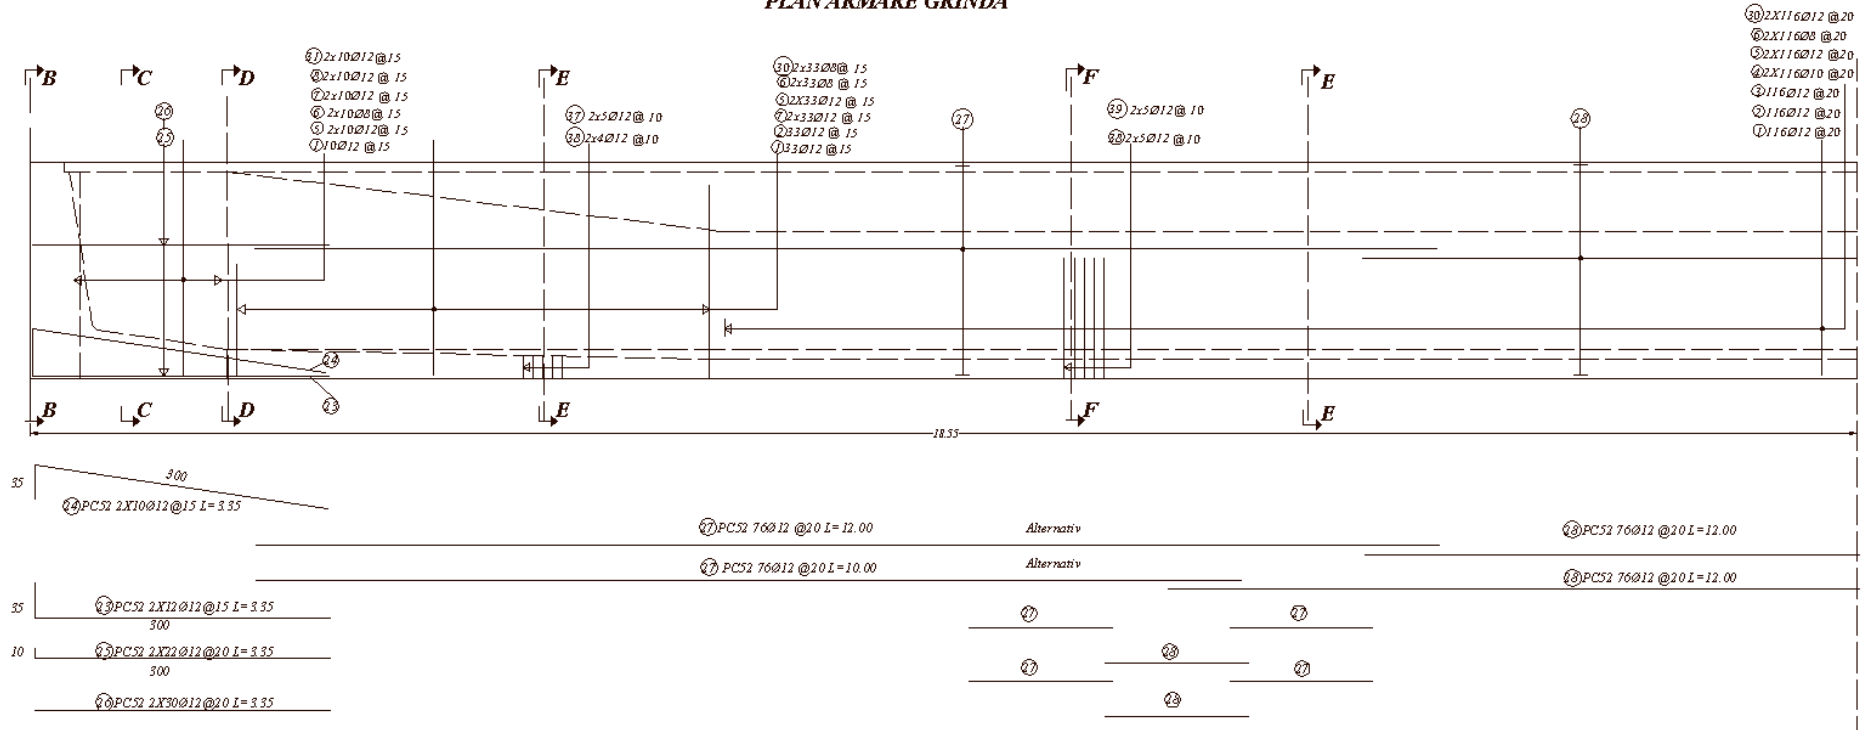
Plan armare grinda chesonată, L=37.10 m
